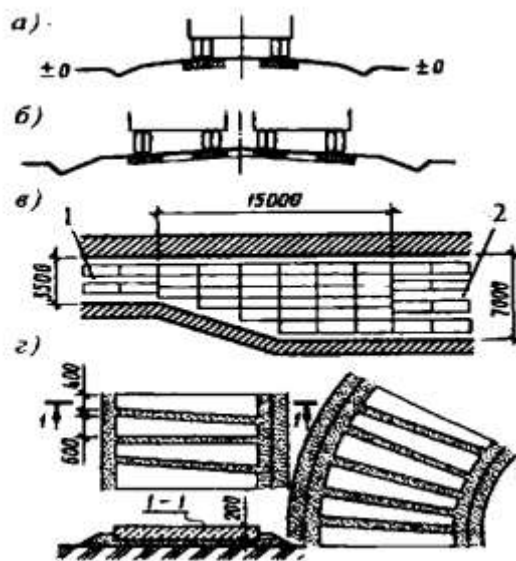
Тимчасові дороги із залізобетонних плит:
